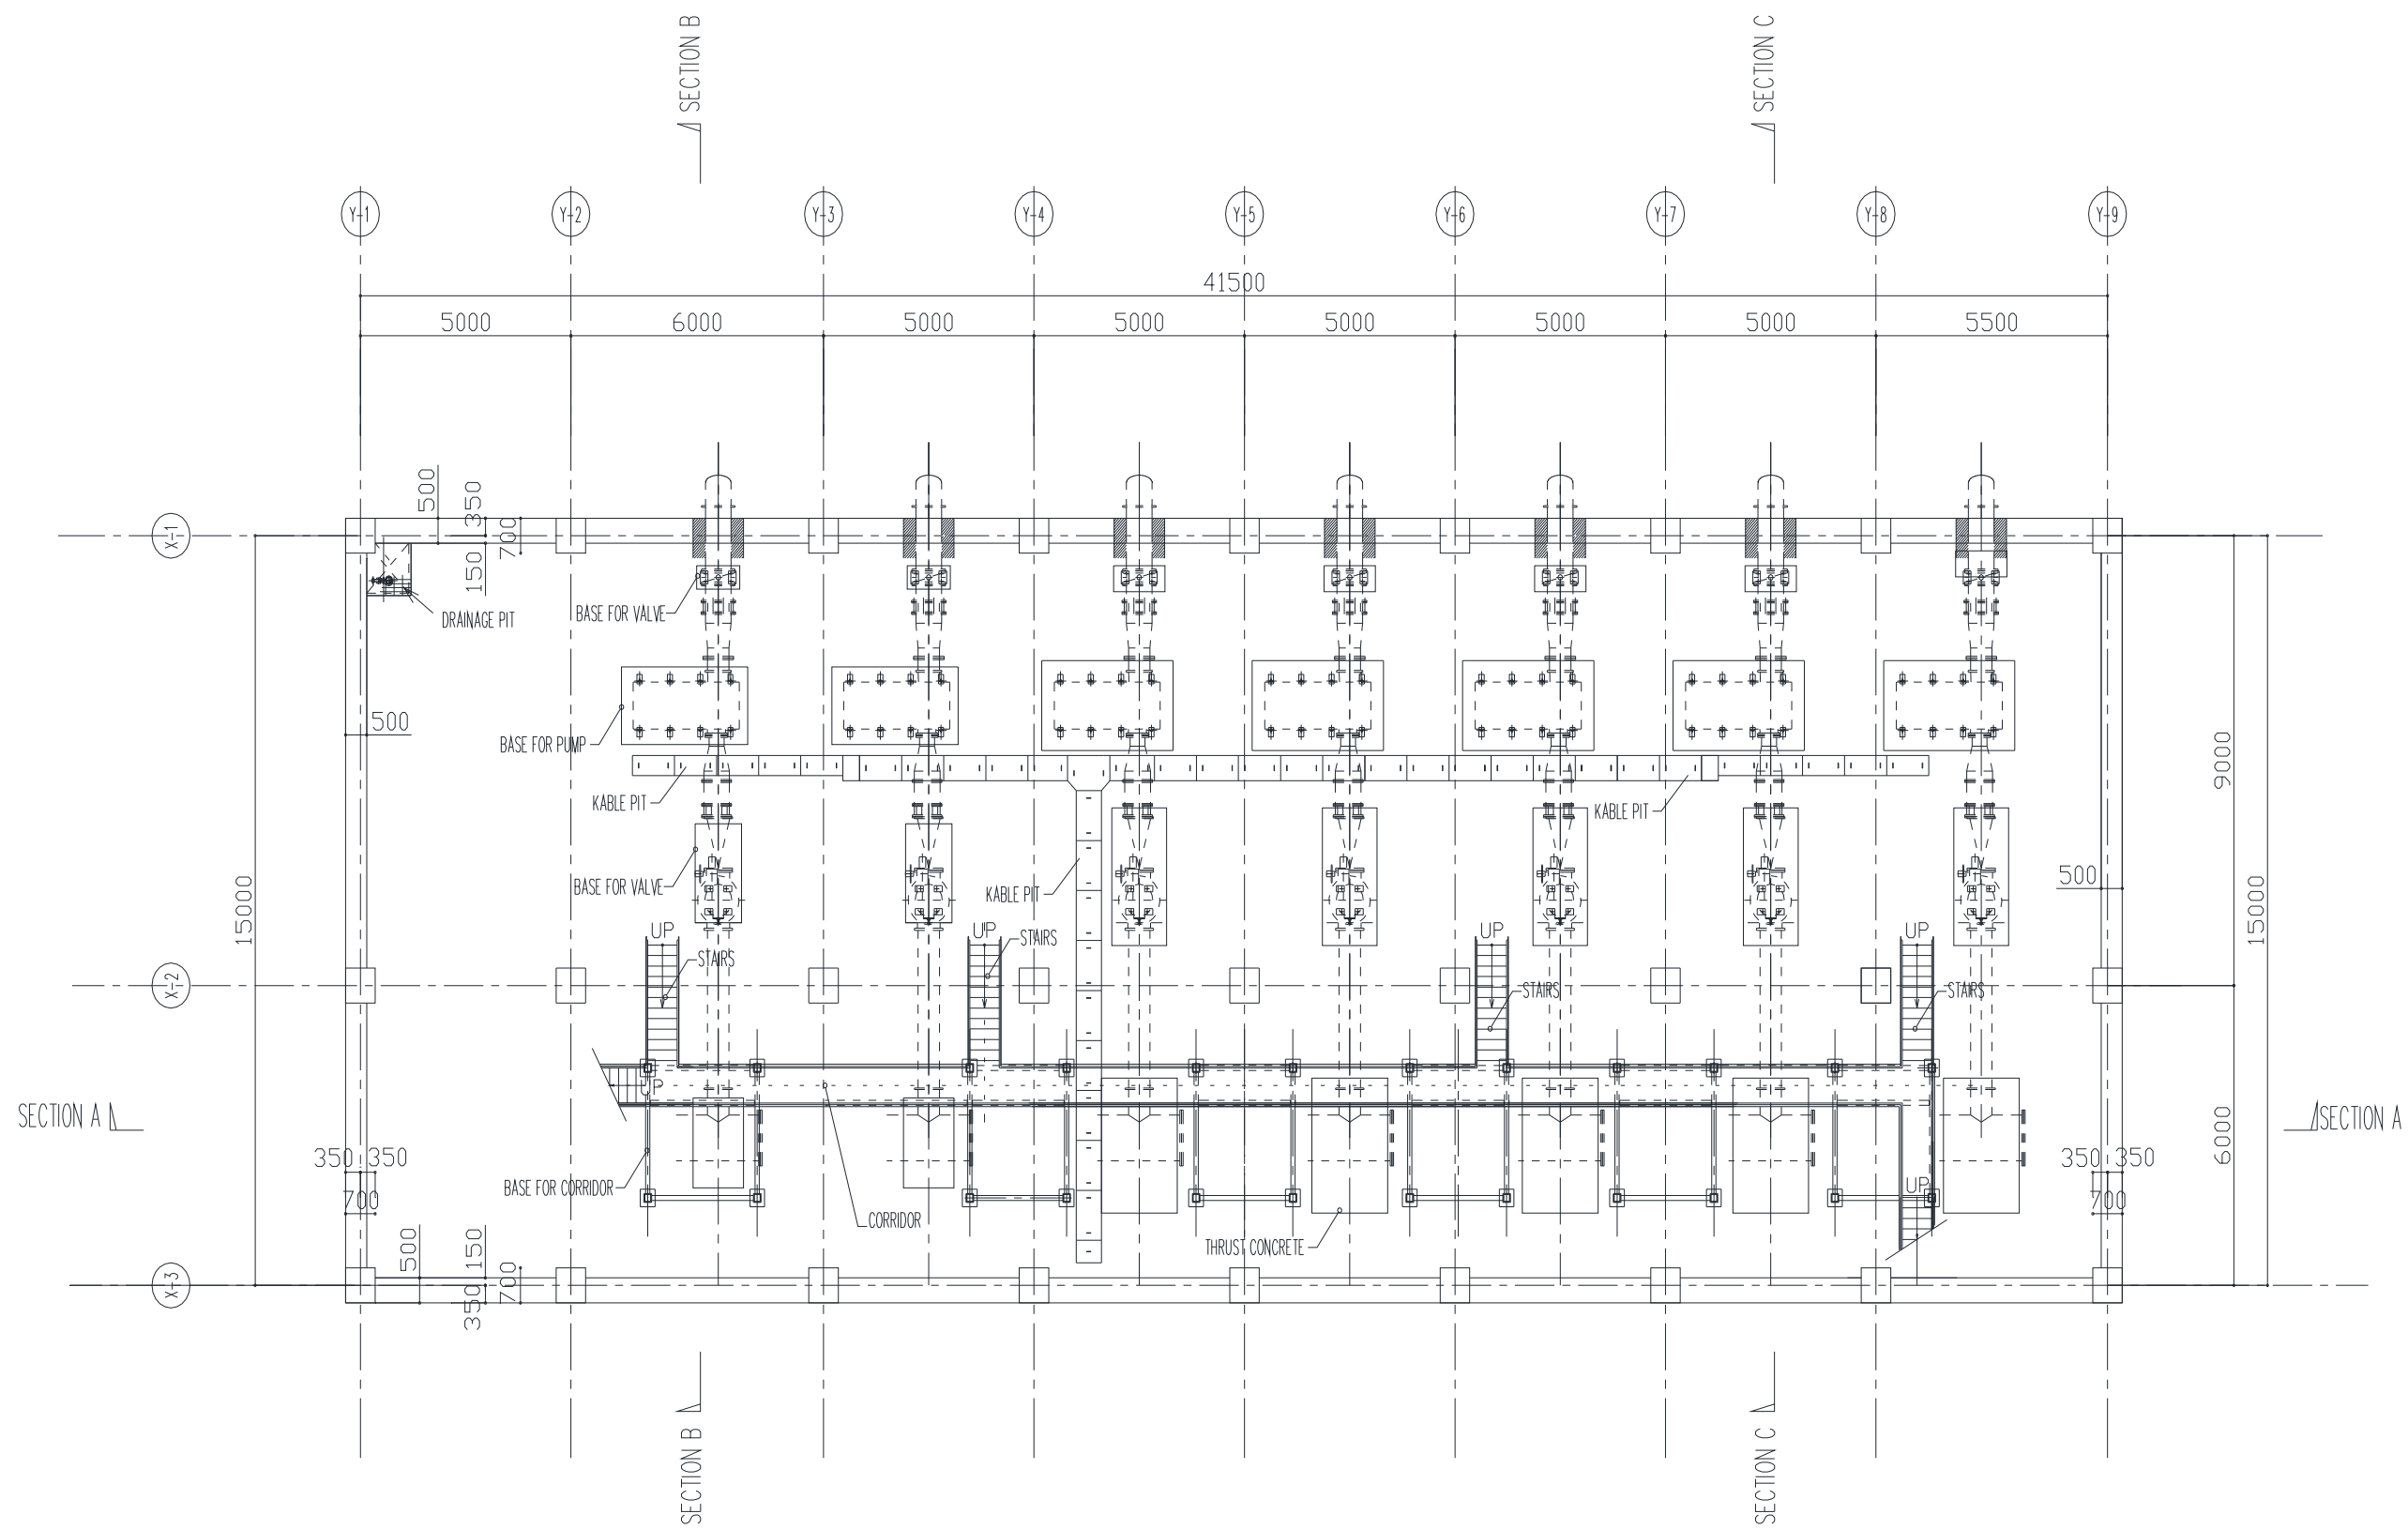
チェナブ系最終配水場ポンプ棟平面図(地下1階)
